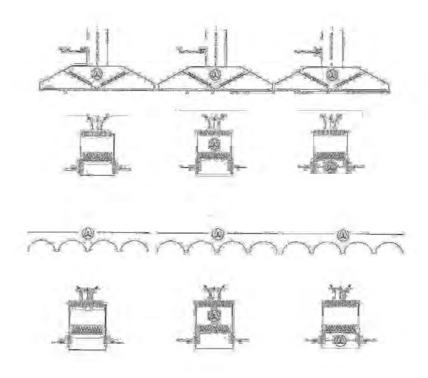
Installazione di apparecchi di tipo A1/ A2/ A3 sotto un sistema di aspirazione con ventilazione forzata
